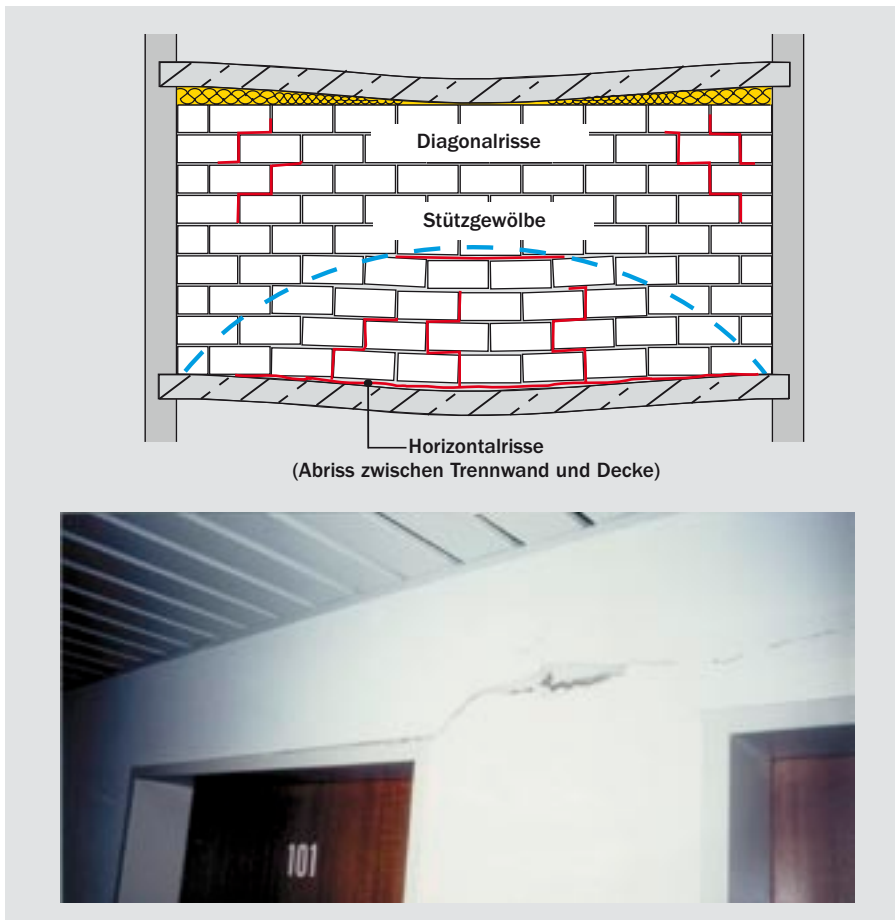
Risse in nicht tragenden Trennwänden infolge Durchbiegung der Geschossdecke
